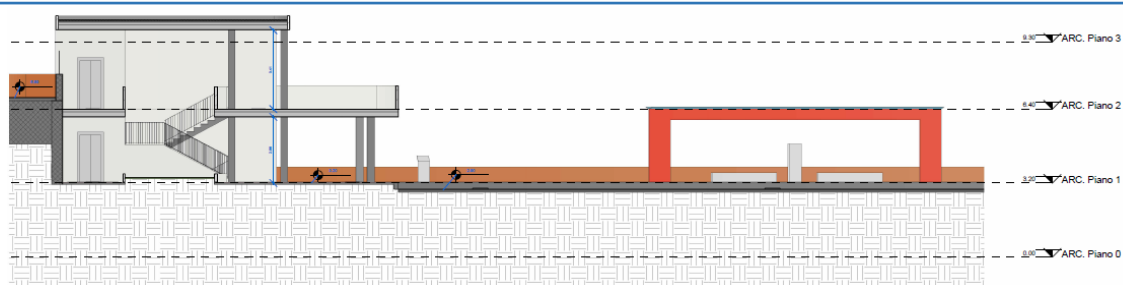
sezione longitudinale sulla banchina del capolinea e sul corpo di collegamento
